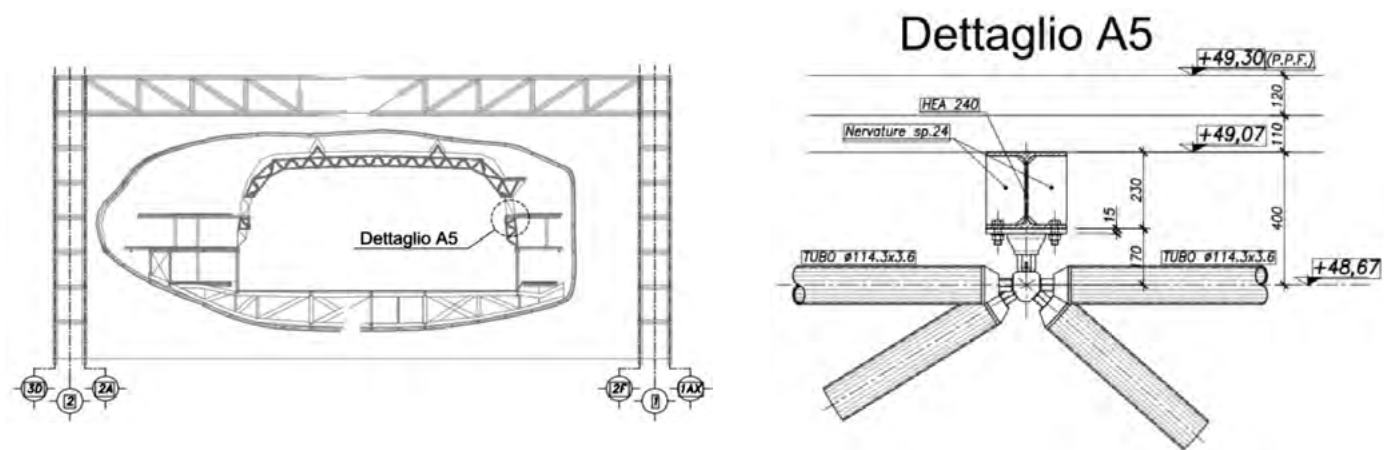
Sezione trasversale dell'auditorium e dettaglio
